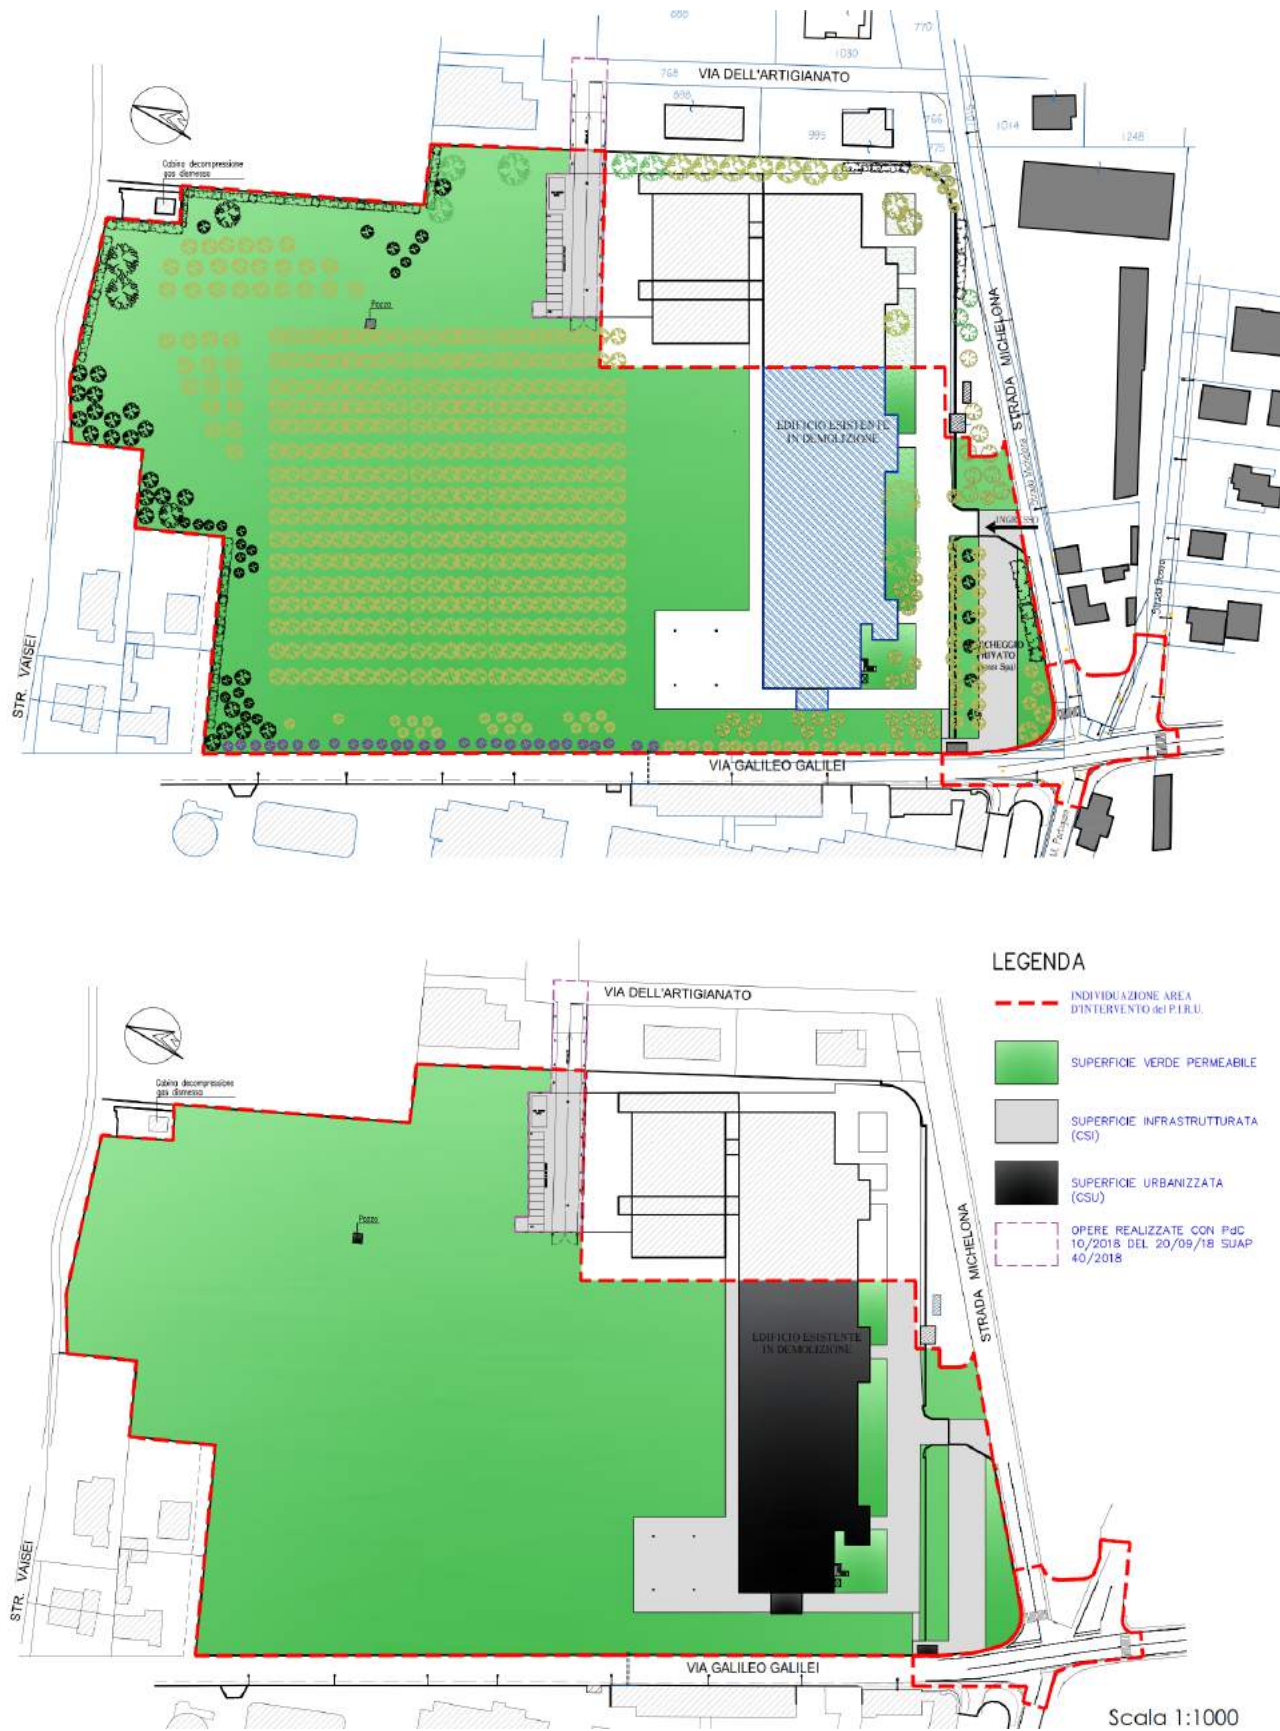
Planimetria dello stato di fatto con rilievo delle alberature e dell'occupazione del suolo
